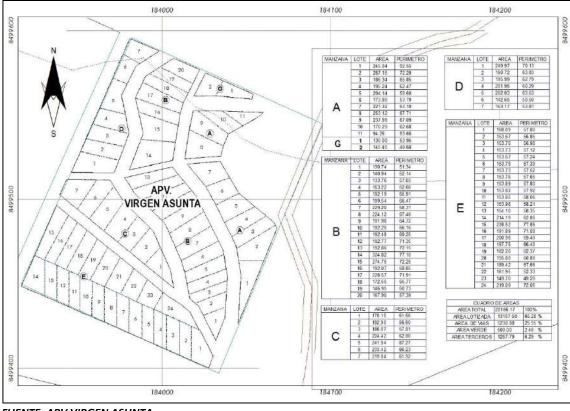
PLANO DE LOTIZACIÓN APV. VIRGEN ASUNTA
